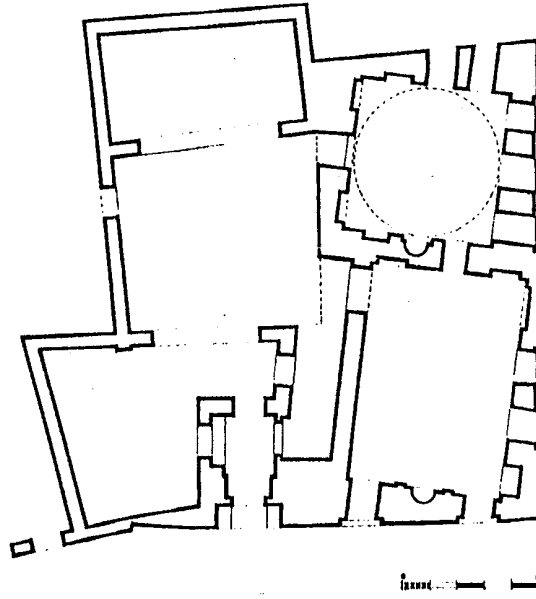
مسقط أفقي لخانة بيبرس الجاشنكير بالقاهرة
